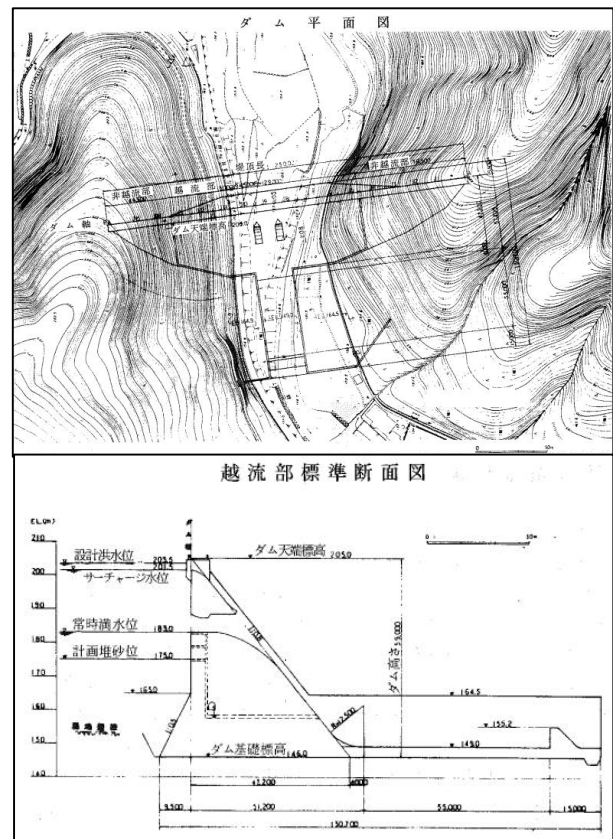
栗栖ダム計画平面図(上)標準断面図(下)
